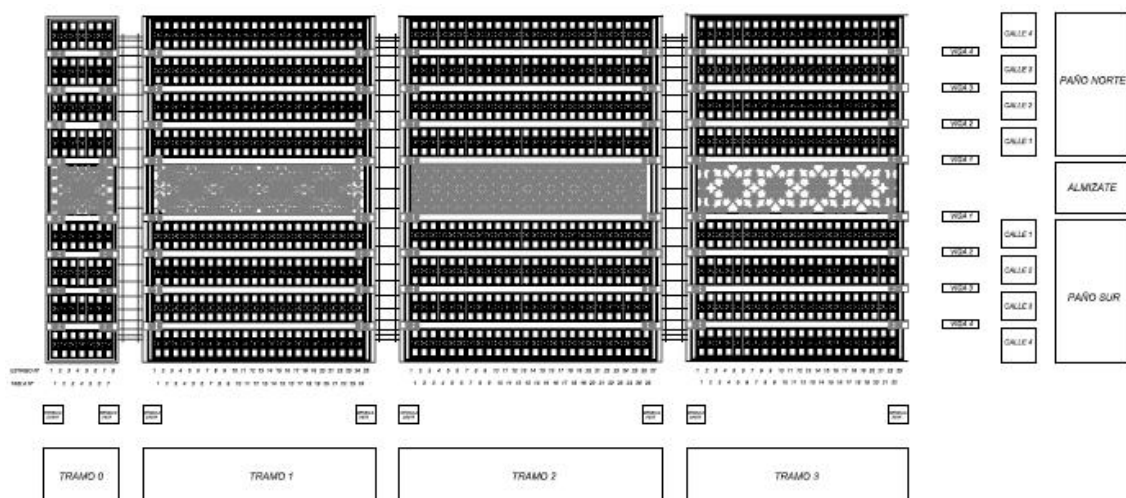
Planta del artesonado de la Concepción indicando cada una de las partes que lo componen.
